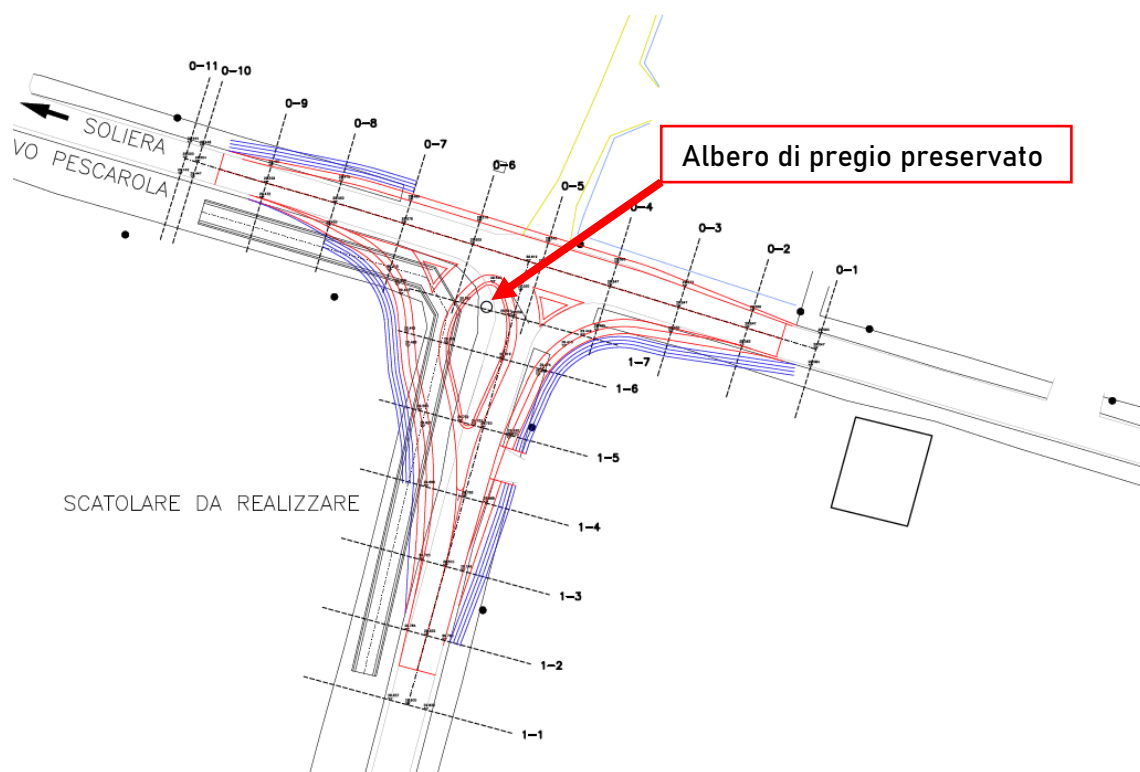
Stralcio della planimetria di progetto dell'intersezione tra via Morello e via Villanova
